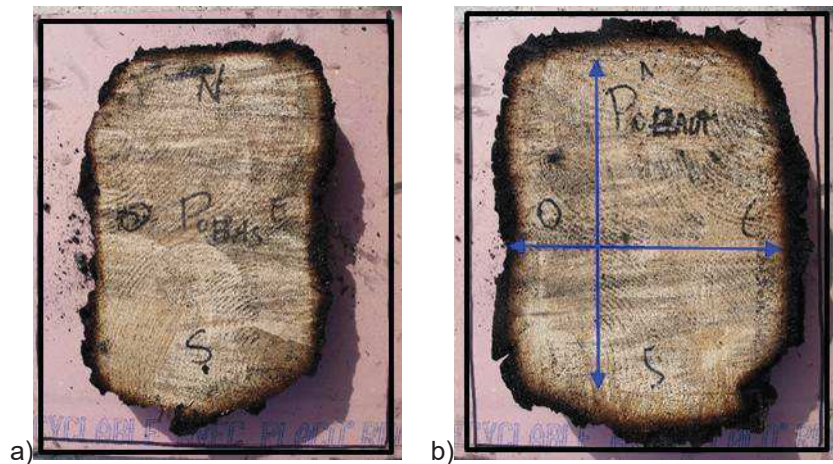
Échantillons prélevés sur le poteau (Essai 3) a) 100cm de haut ; b) 200cm de haut (le contour noir représente la section initiale de poteau)
